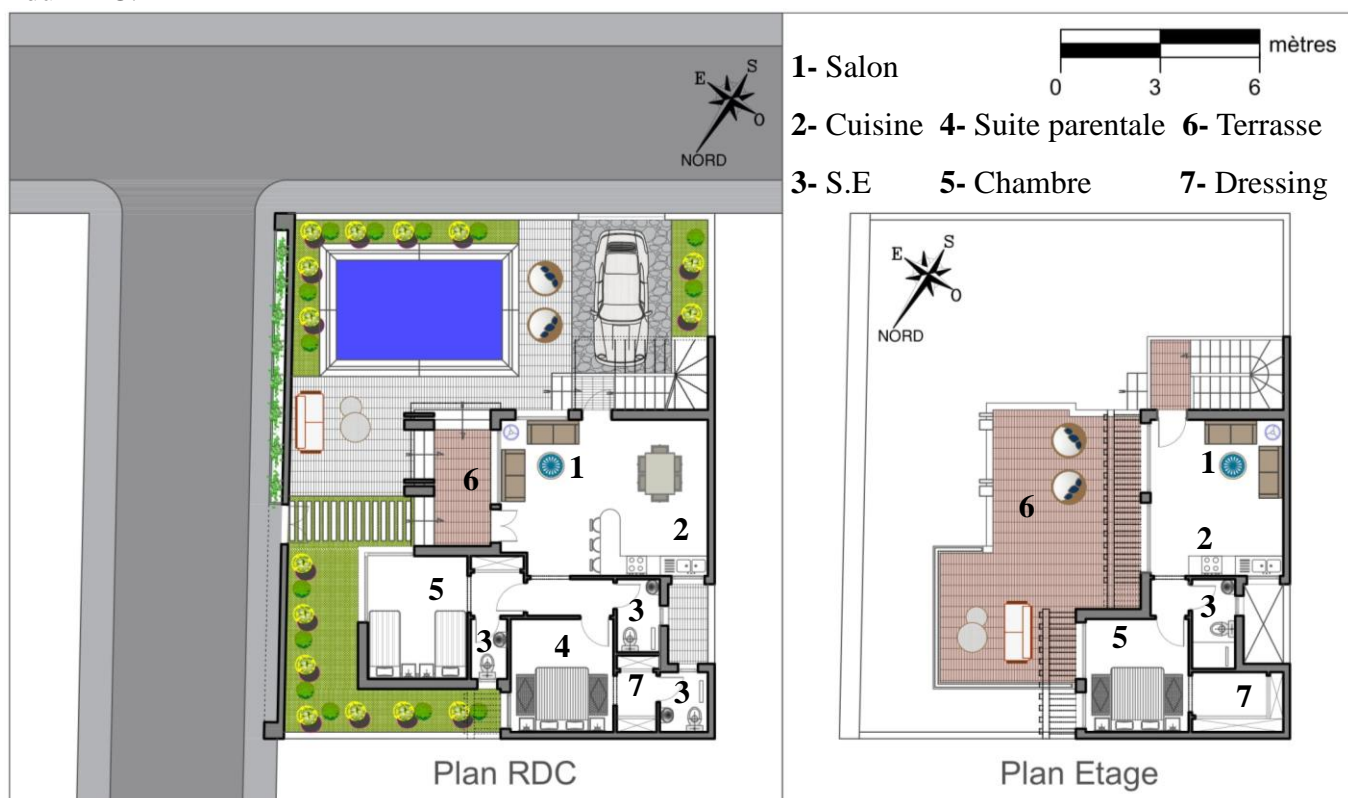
Esquisse C – Plans RDC et 1^{er} étage
